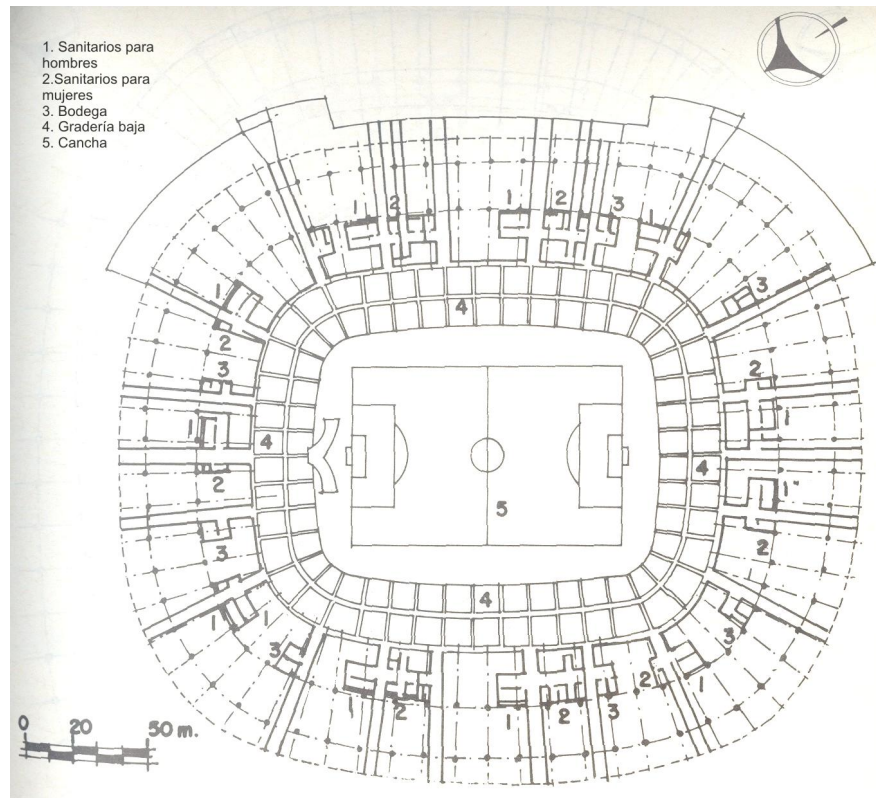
Planta de túneles y gradería baja del estadio Azteca
